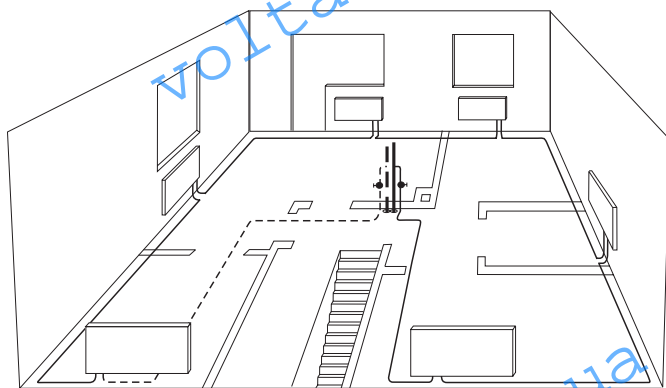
Разводка трубопроводов в виде однетрубной петли
